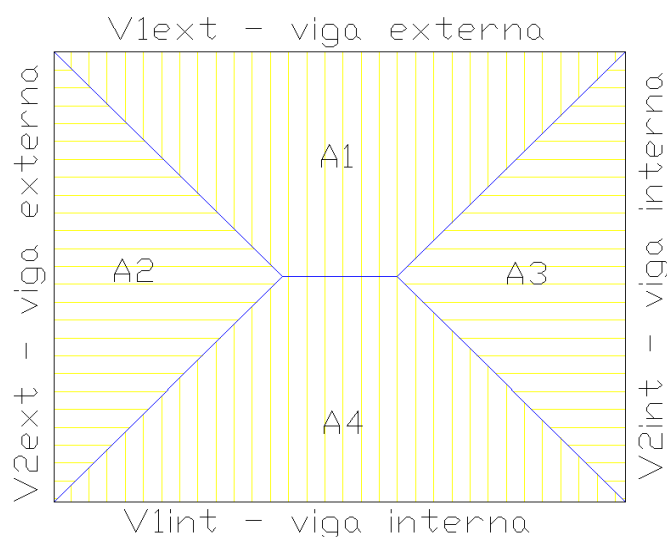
Divisão do carregamento das lajes e transmissão para as vigas através do método telhado
